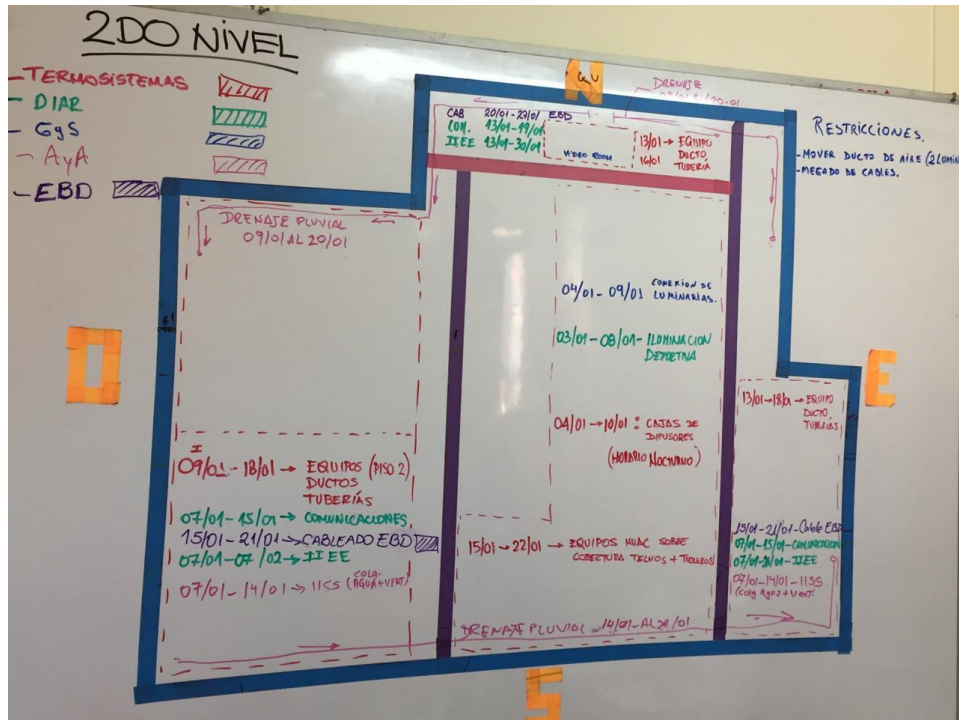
Plan semanal realizado con los subcontratistas de instalaciones. Fuente: Elaboración Propia.
